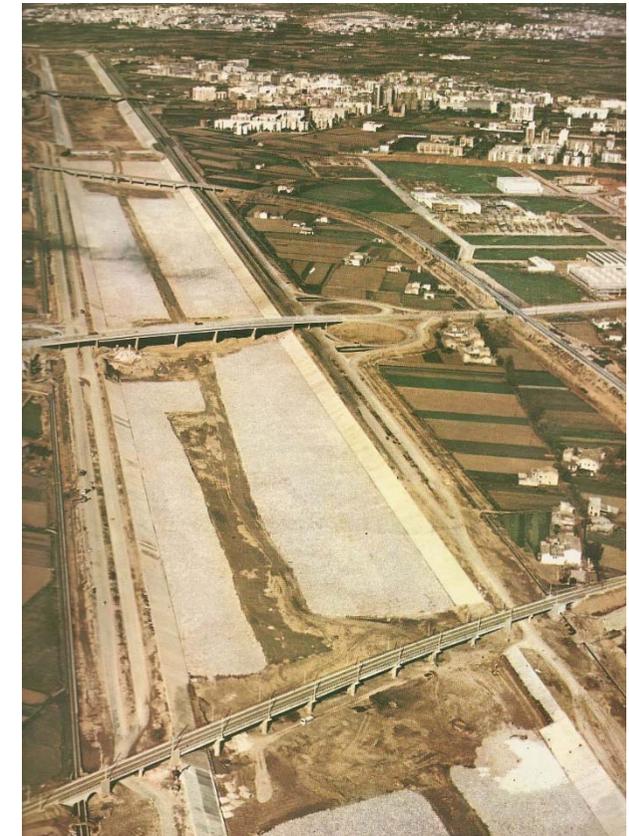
RPA02 Plan Sur en 1970. Fuente: Folleto informativo del Plan Sur.
